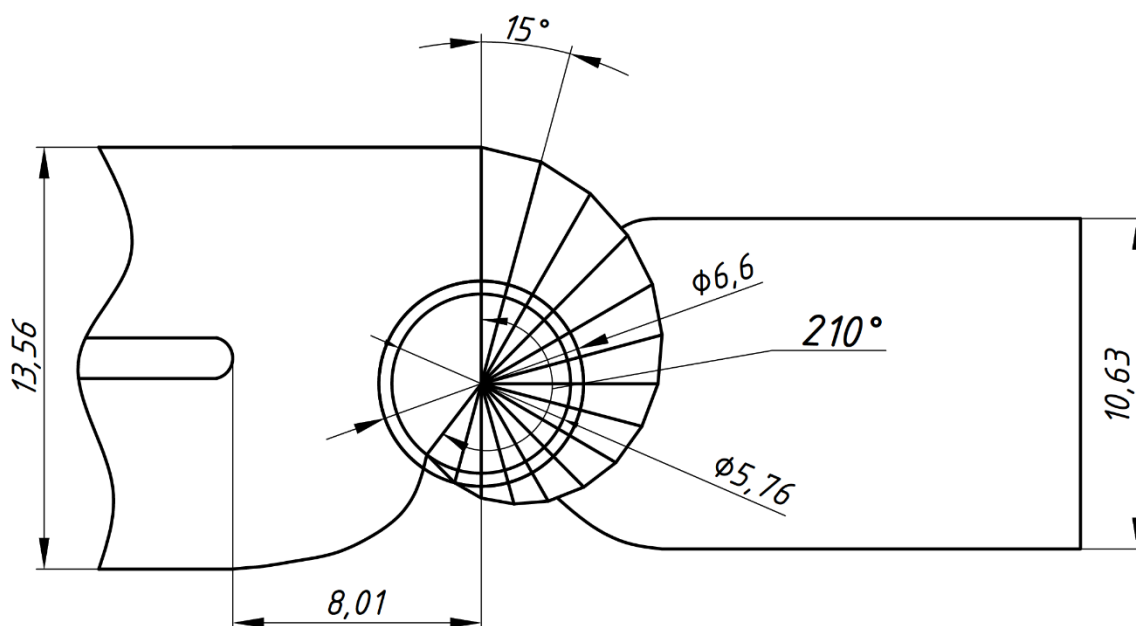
План бетонной спиральной камеры гидротурбины ПЛ40а-В
